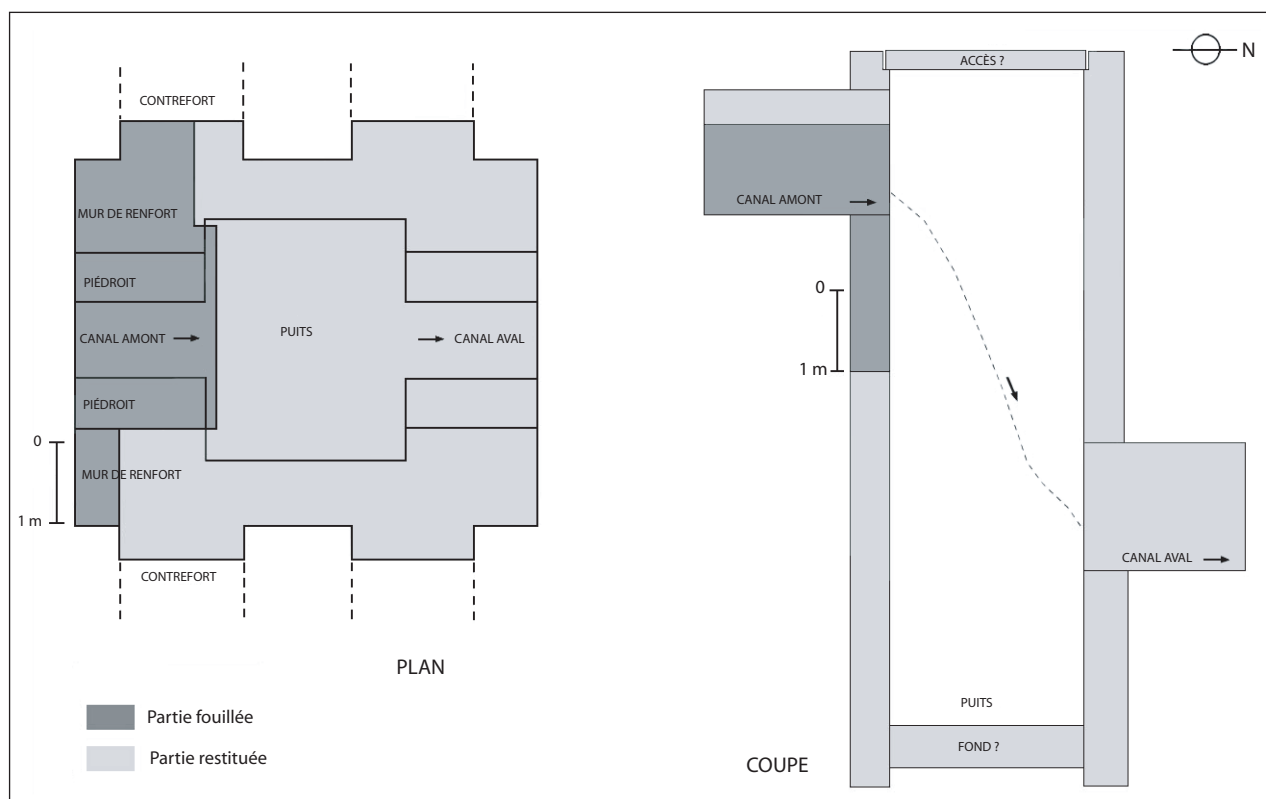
Plan et coupe restitués du premier puits de rupture de pente de la cascade (L. Borau).
